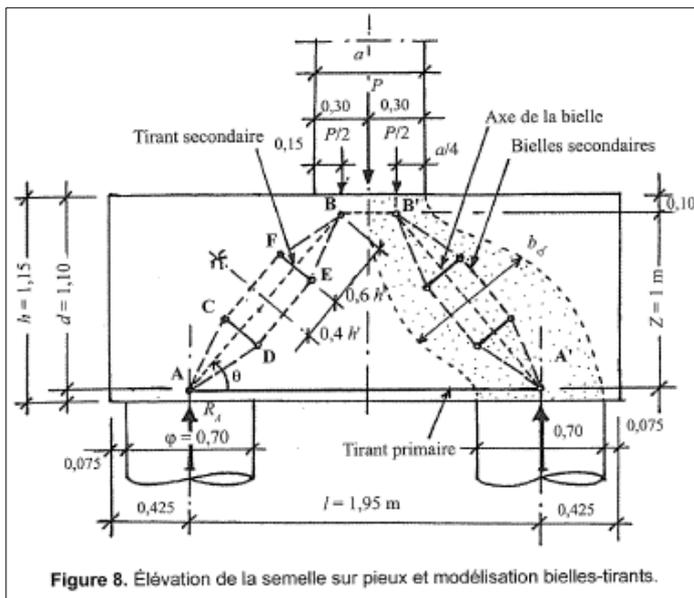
Élévation de la semelle sur pieux et modélisation bielles-tirants.
